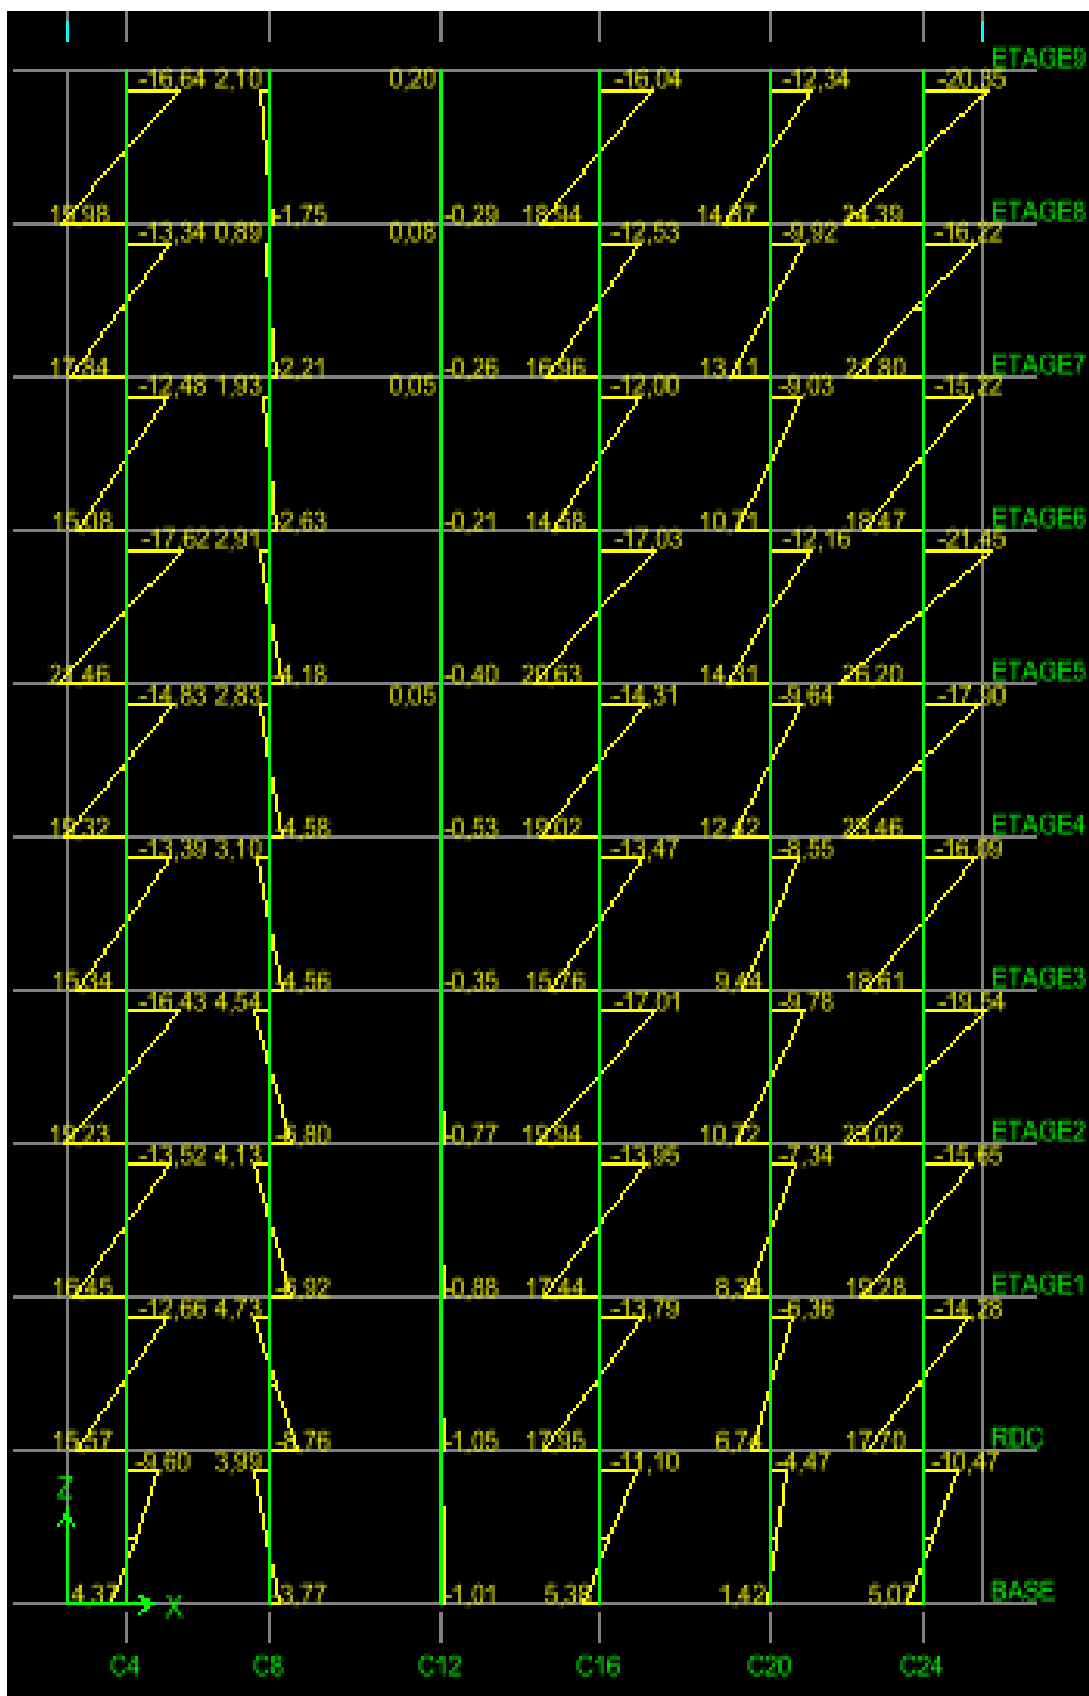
Exemple du Moment 2-2 au poteau C20 à l'ELU
